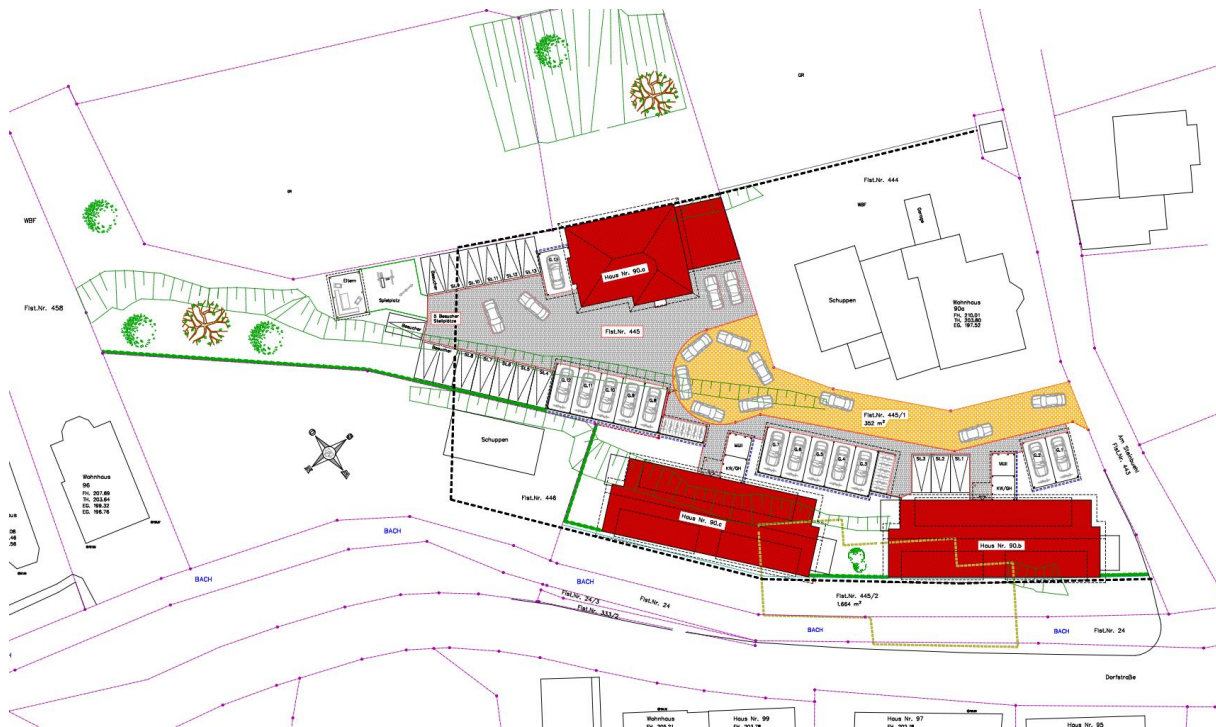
Übersichtslageplan Bebauungskonzept "Am Steinbühl / Alte Säge"; Quelle: Bau- und Planungsbüro Peter Kress, Rheinau-Linx
